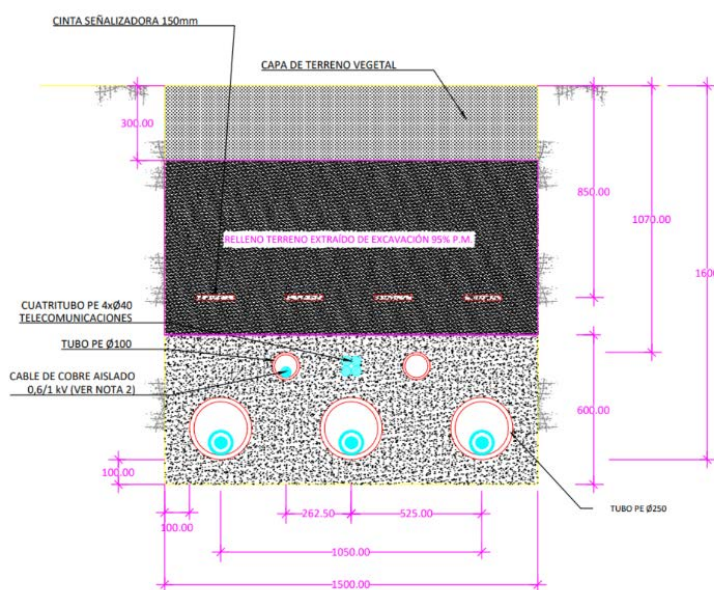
Sección tipo de la zanja proyectada. Fuente: RH Estudio.
